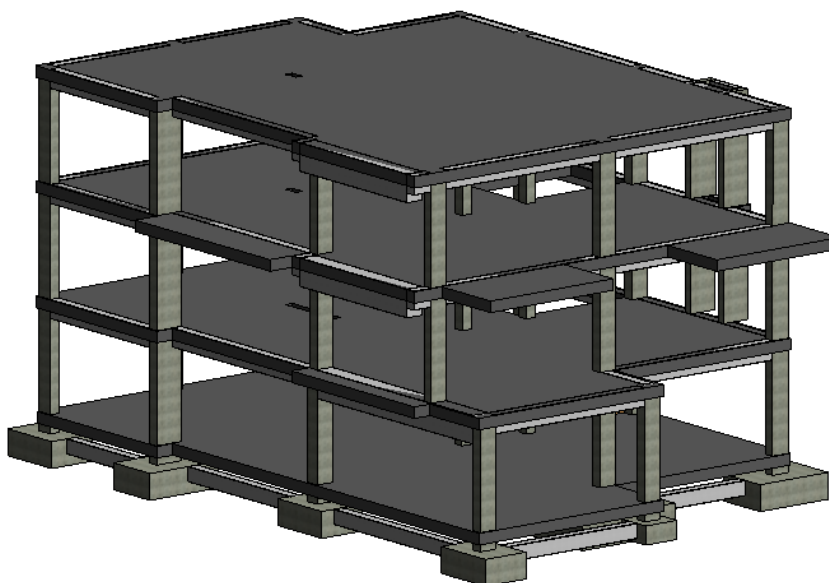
Elementos de Fundações, Pilares, Vigas e Pisos do Modelo Virtual.
